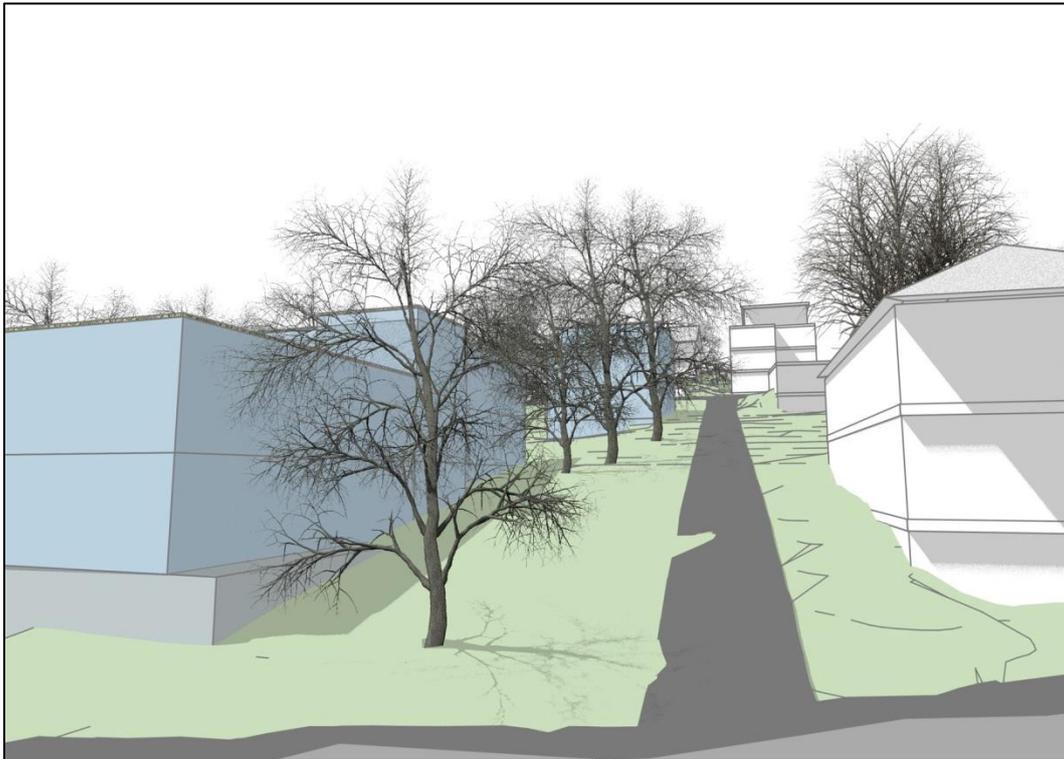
Weg zwischen Waldstraße und Schillerstraße
